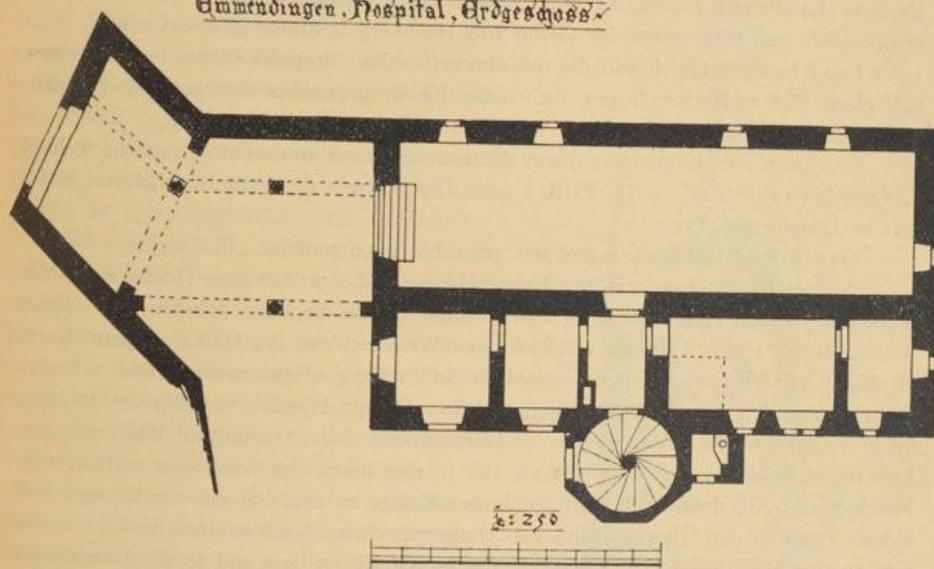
Emmendingen, Hospital. Grundriss des Erdgeschosses.
